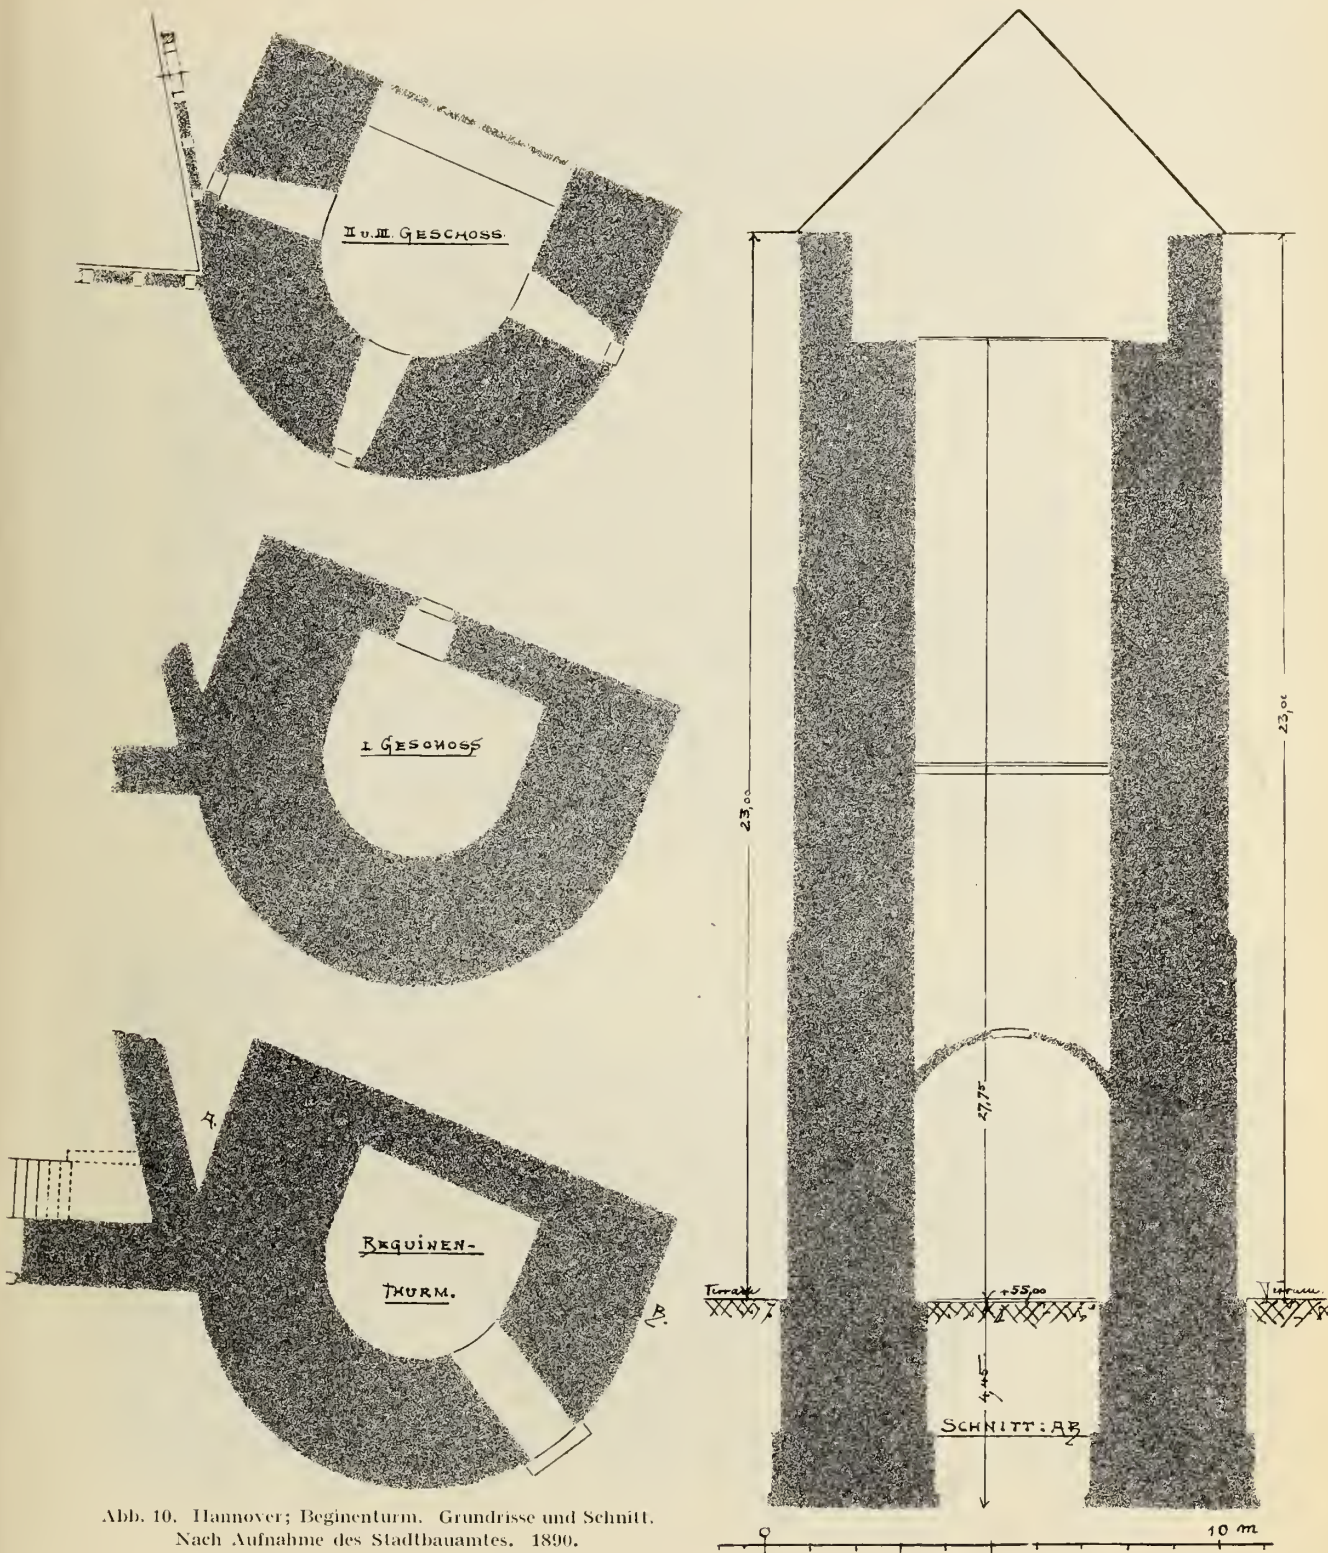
Hannover; Beginenturm. Grundrisse und Schnitt.
